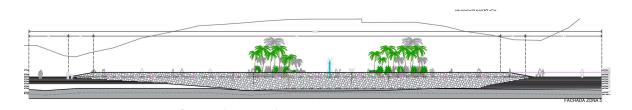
Fachada del proyecto en la zona 5. Construcción del Malecón Salina Cruz.
